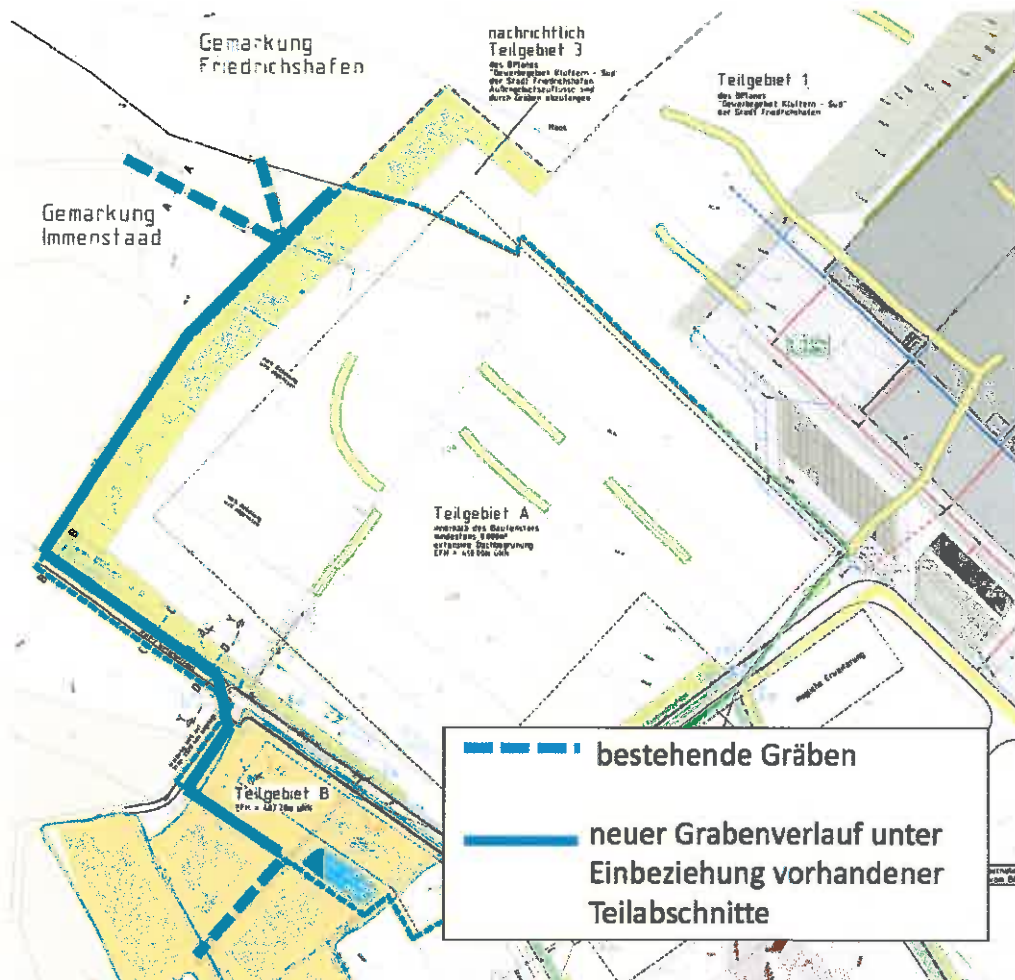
Lageplan des neuen Grabensystems (Grundlage Planung Weber-Ingenieure, Pforzheim)
